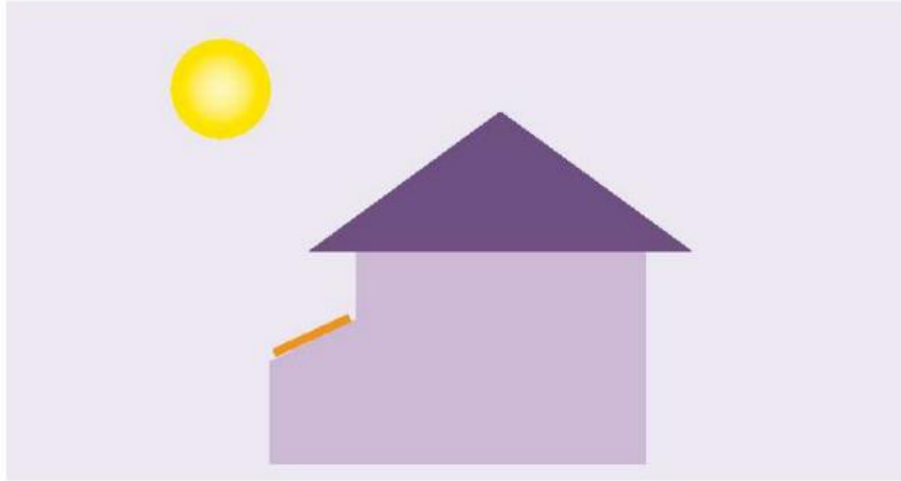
Installation du capteur sur un volume du bâtiment.
